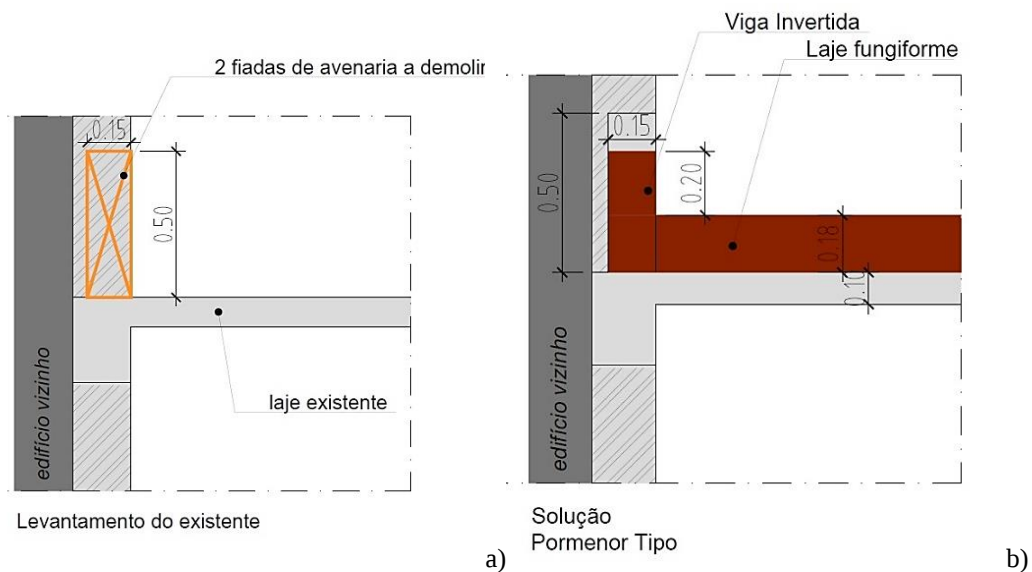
Laje do piso tipo: a) levantamento da situação junto aos edifícios contíguos; b) o pormenor tipo com a solução de reforço
